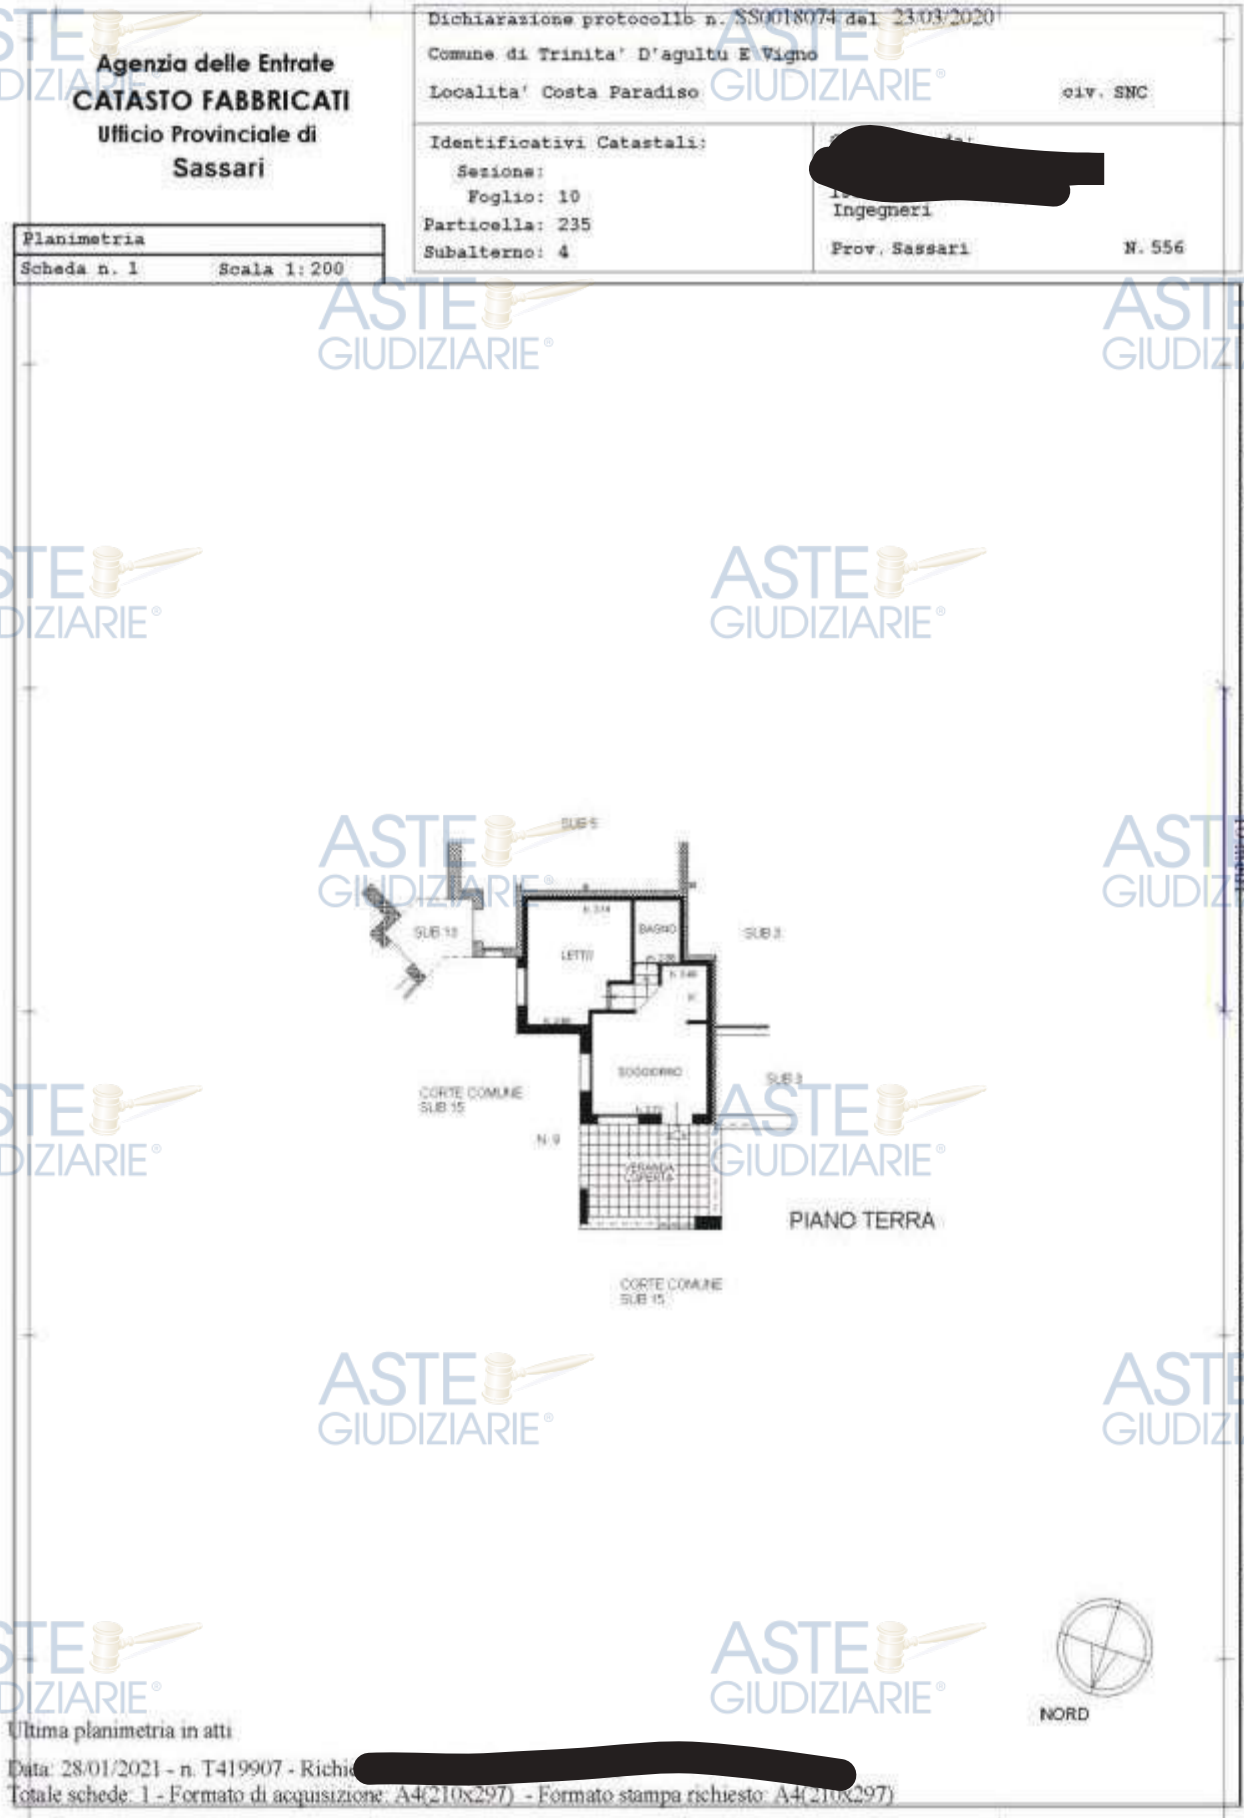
Visura planimetrica catastale aggiornata Fig. 10 Part. 235 Sub 4
